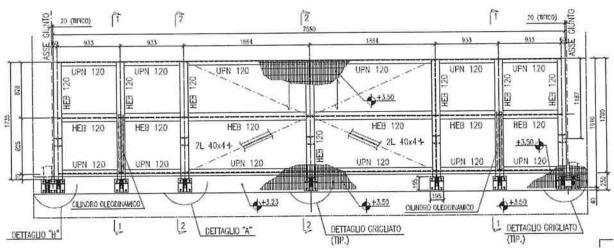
MODULO TIPO 1; PIANTA
